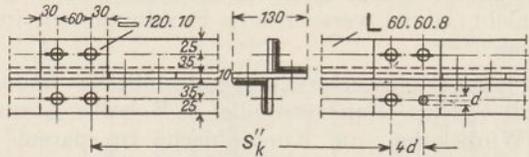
Druckstab aus 2 übereck stehenden Winkelisen.
